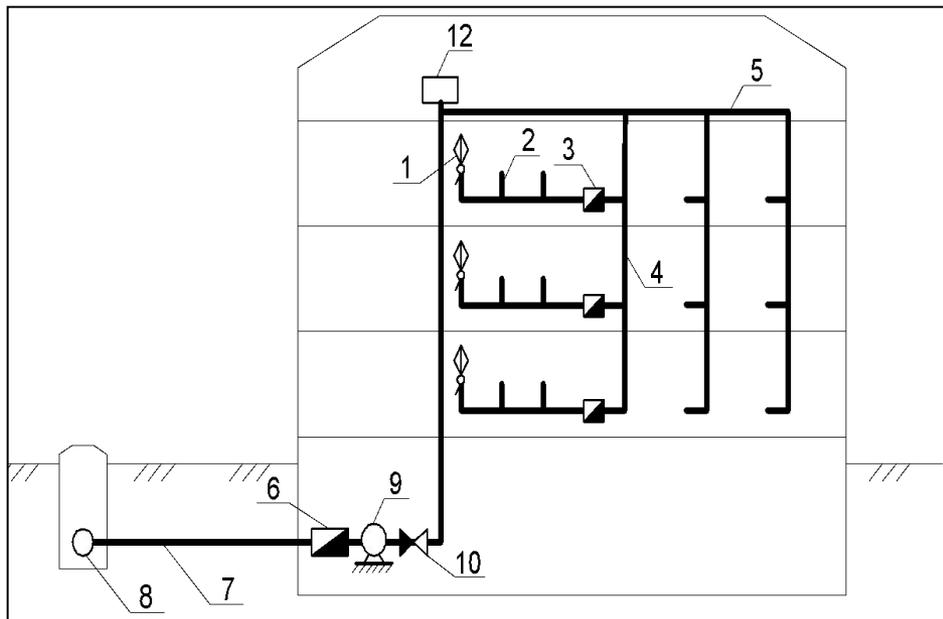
Схема водоснабжения здания с местной насосной установкой и водонапорным баком:
